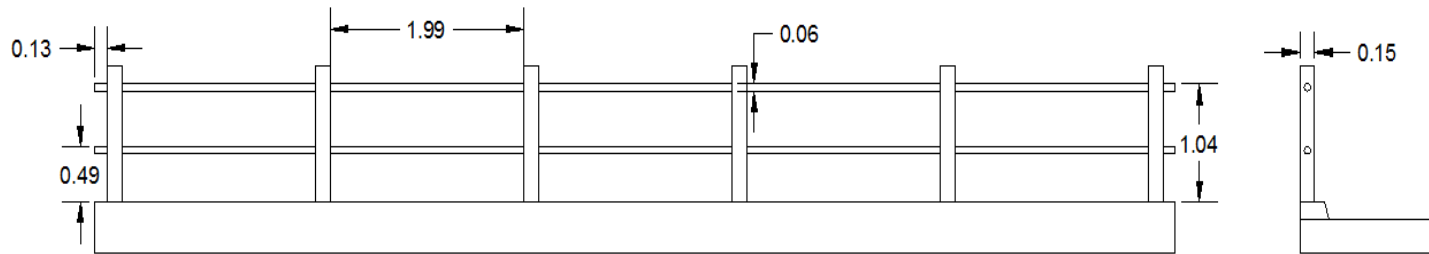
Baranda promedio con pasamanos metálicos y postes en concreto.
